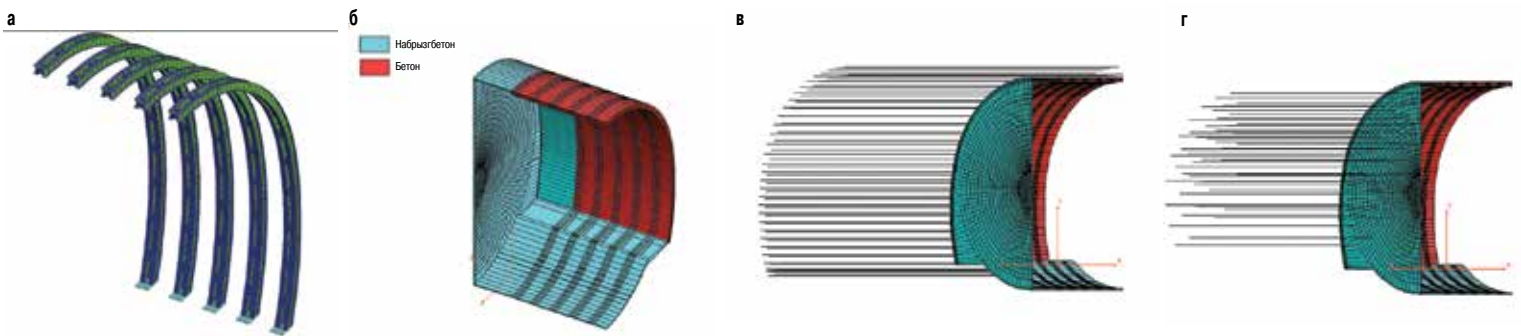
Фрагменты расчетной схемы: а — арки; б — набрызгбетон; в — экран из труб по контуру выработки; г — стекловолоконные трубы в забое
